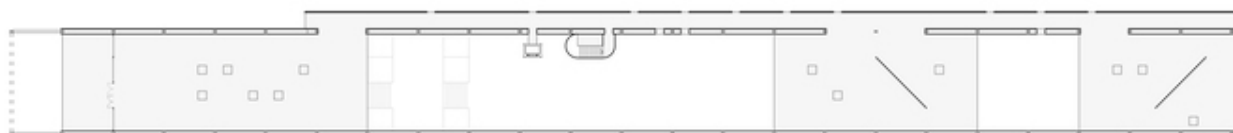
Planta do 1º pavimento do museu marítimo
